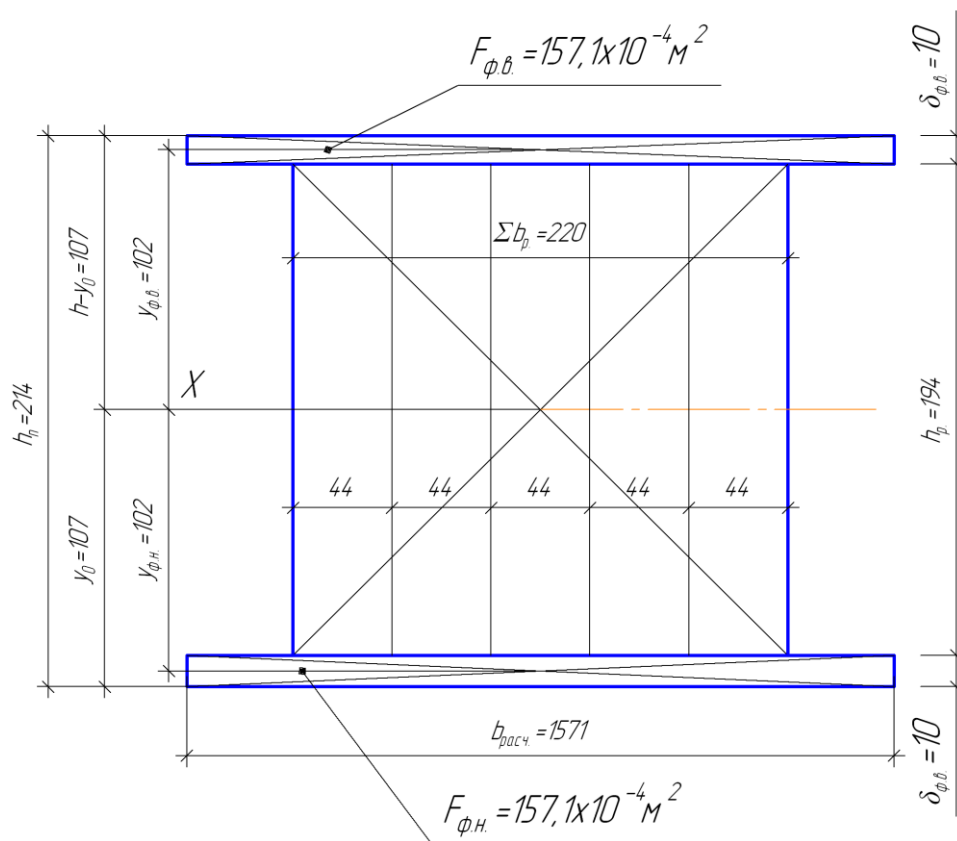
Расчетное поперечное сечение плиты покрытия
